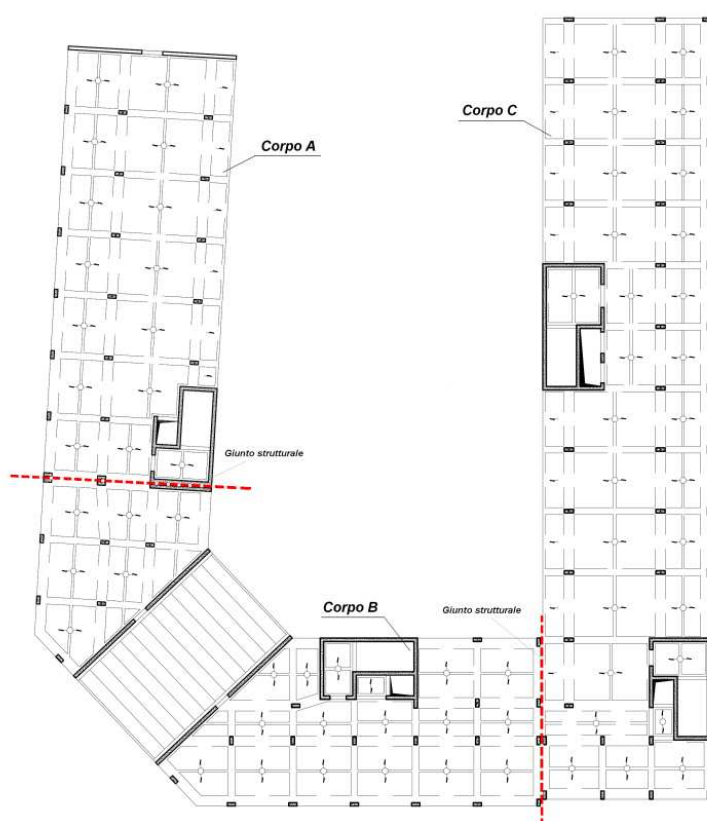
Pianta di carpenteria di un piano tipo della struttura a base fissa
